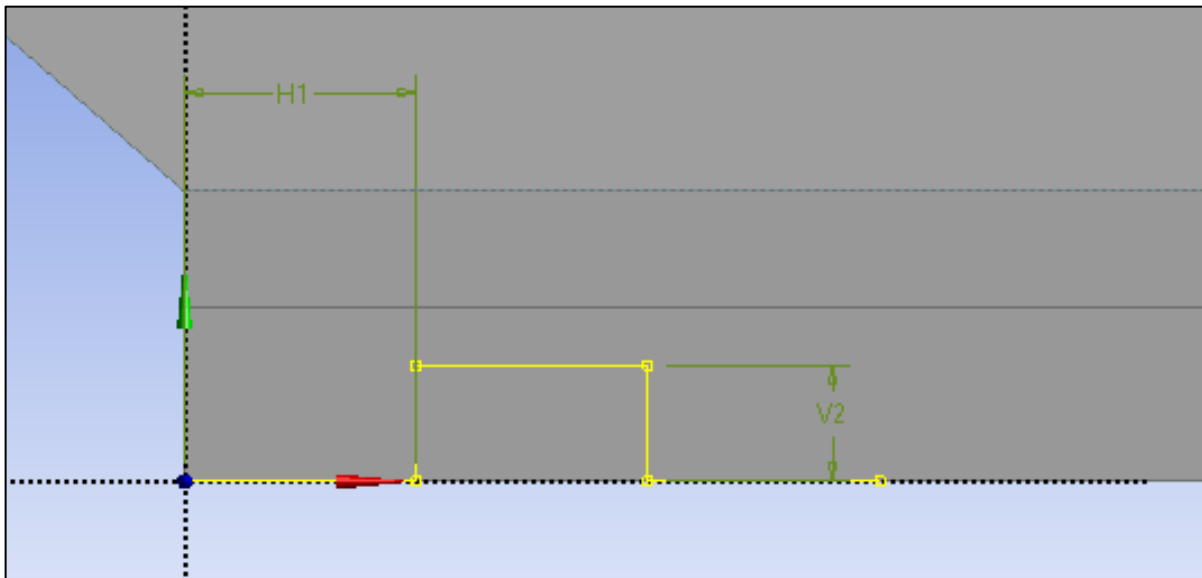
Parâmetros da viga do teto próxima a Coluna “B”
